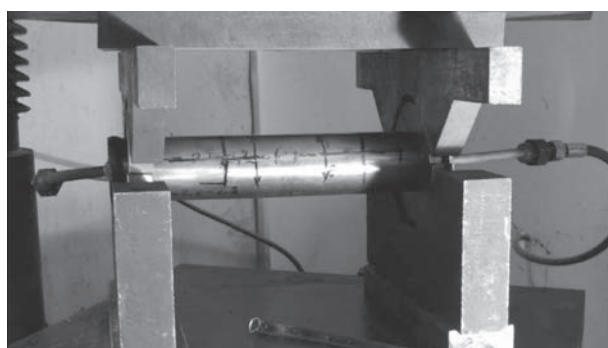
Цилиндрический образец № 01 (76,1×3,0)
